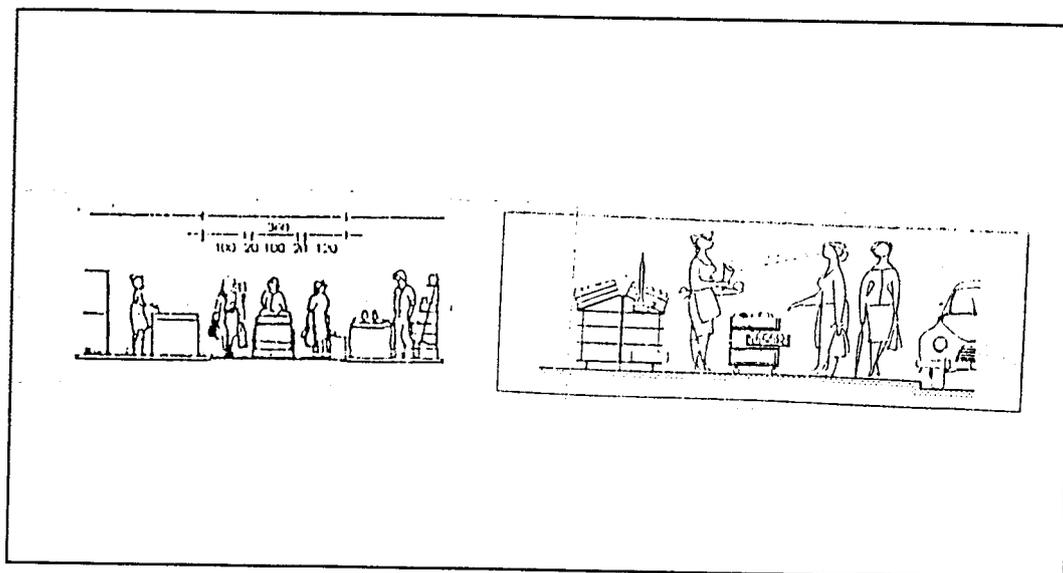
Pola Sirkulasi dalam Bangunan
